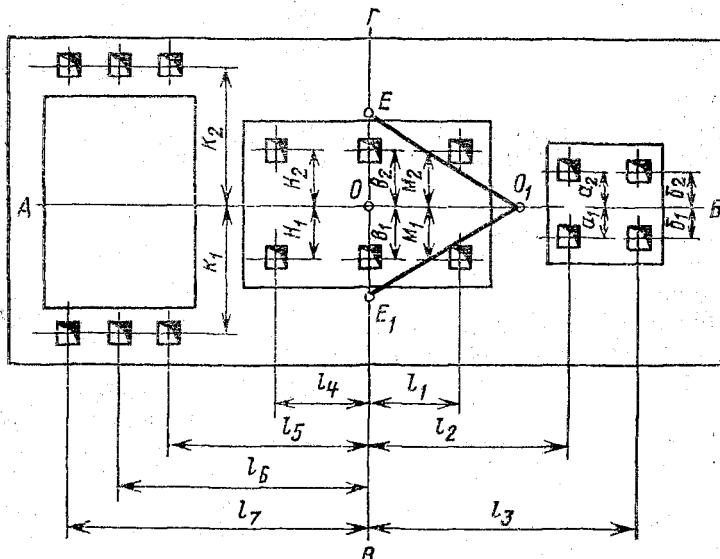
Схема замеров верхнего пояса фундамента трехмашинного агрегата
